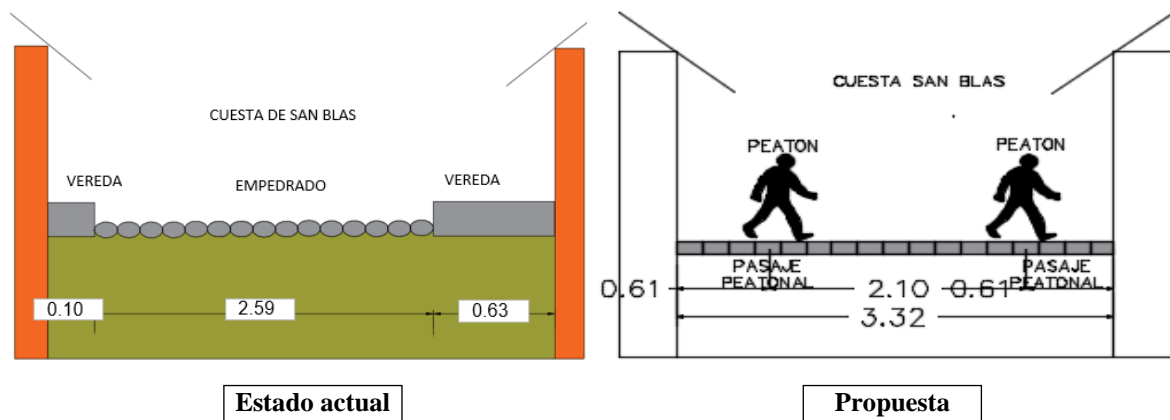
Propuesta de la sección transversal para la calle Cuesta San Blas
